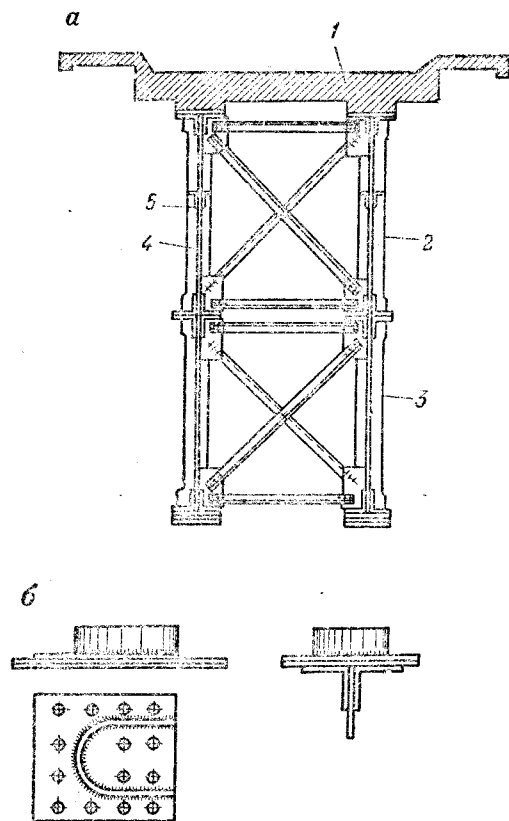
Пролетное строение с железобетонной плитой (с ездой на балласте):
